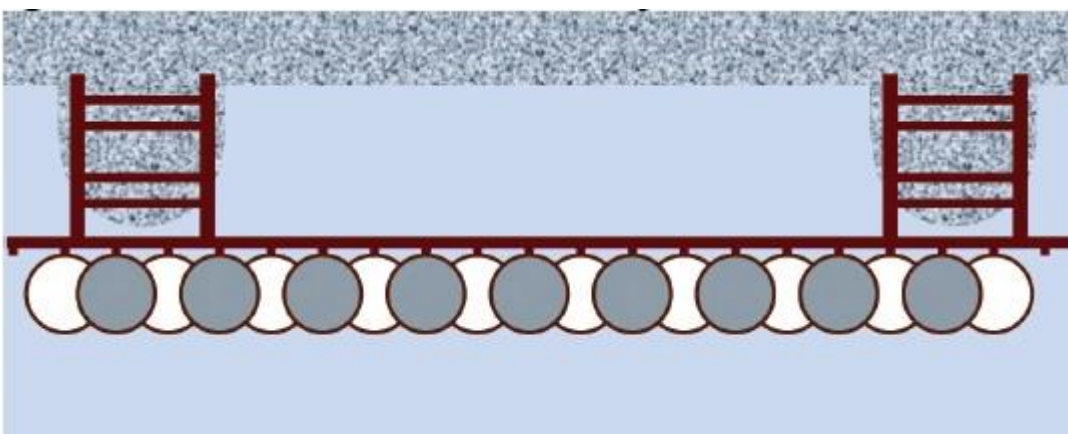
Segunda fase de execução da cortina de estacas da barragem de Walter F. George [9]
